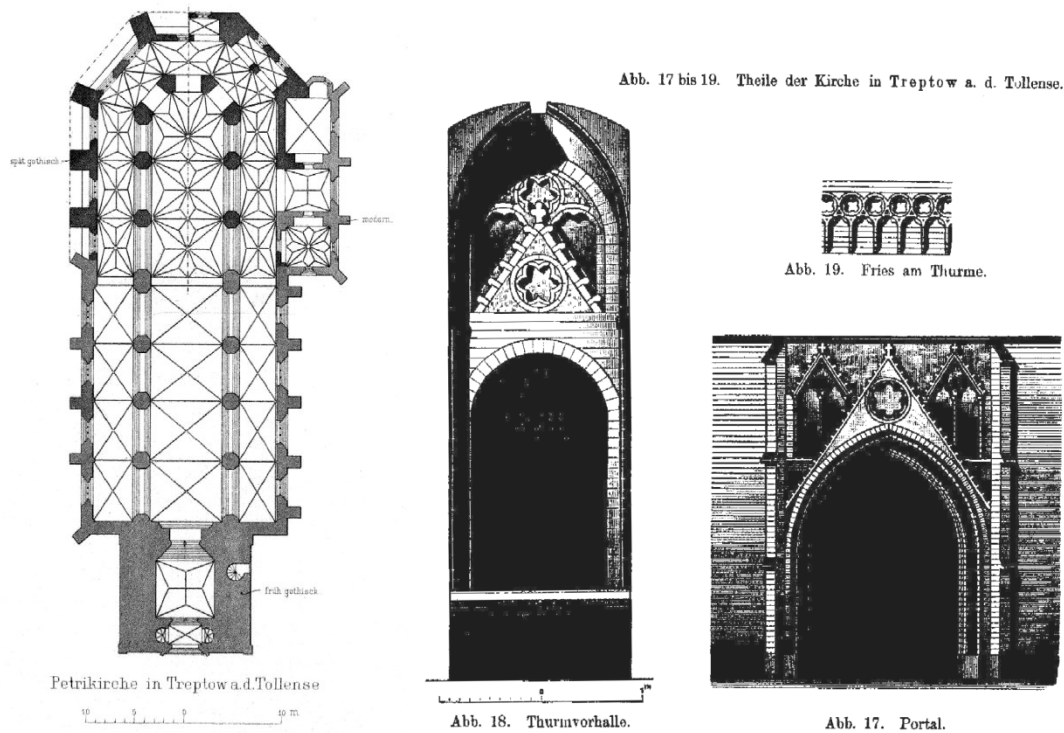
Grundriss der St. Petri-Kirche und architektonische Details (Lutsch, 1889)
